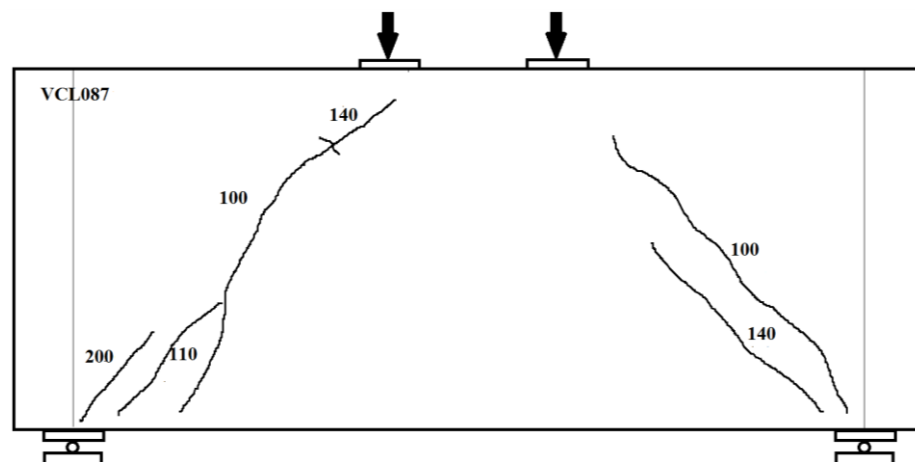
Esquema de fissuração da viga VCL087.
